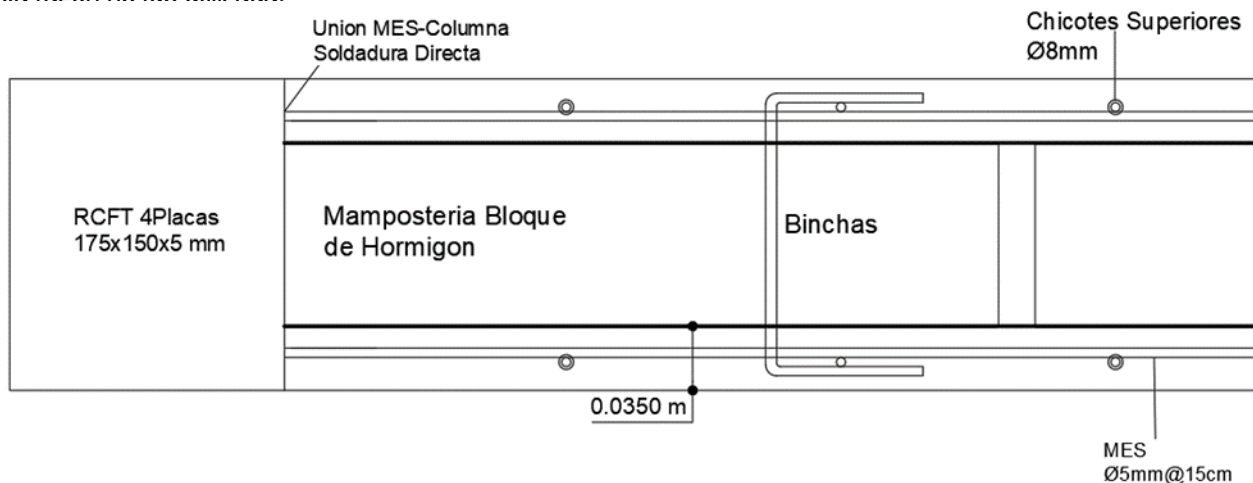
Esquema en planta de posible conexión entre columnas y enchape del prototipo I
